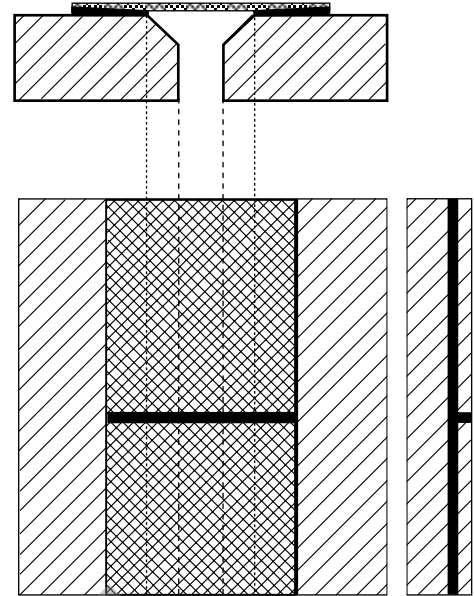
Beispiel für die Ausführung einer Stoßstelle im Bereich Bandanschluss
